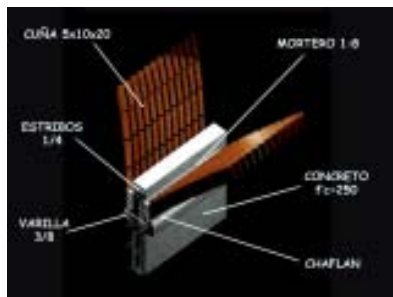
Trabe "T" de hormigón armado, para recibir dos bóvedas.
